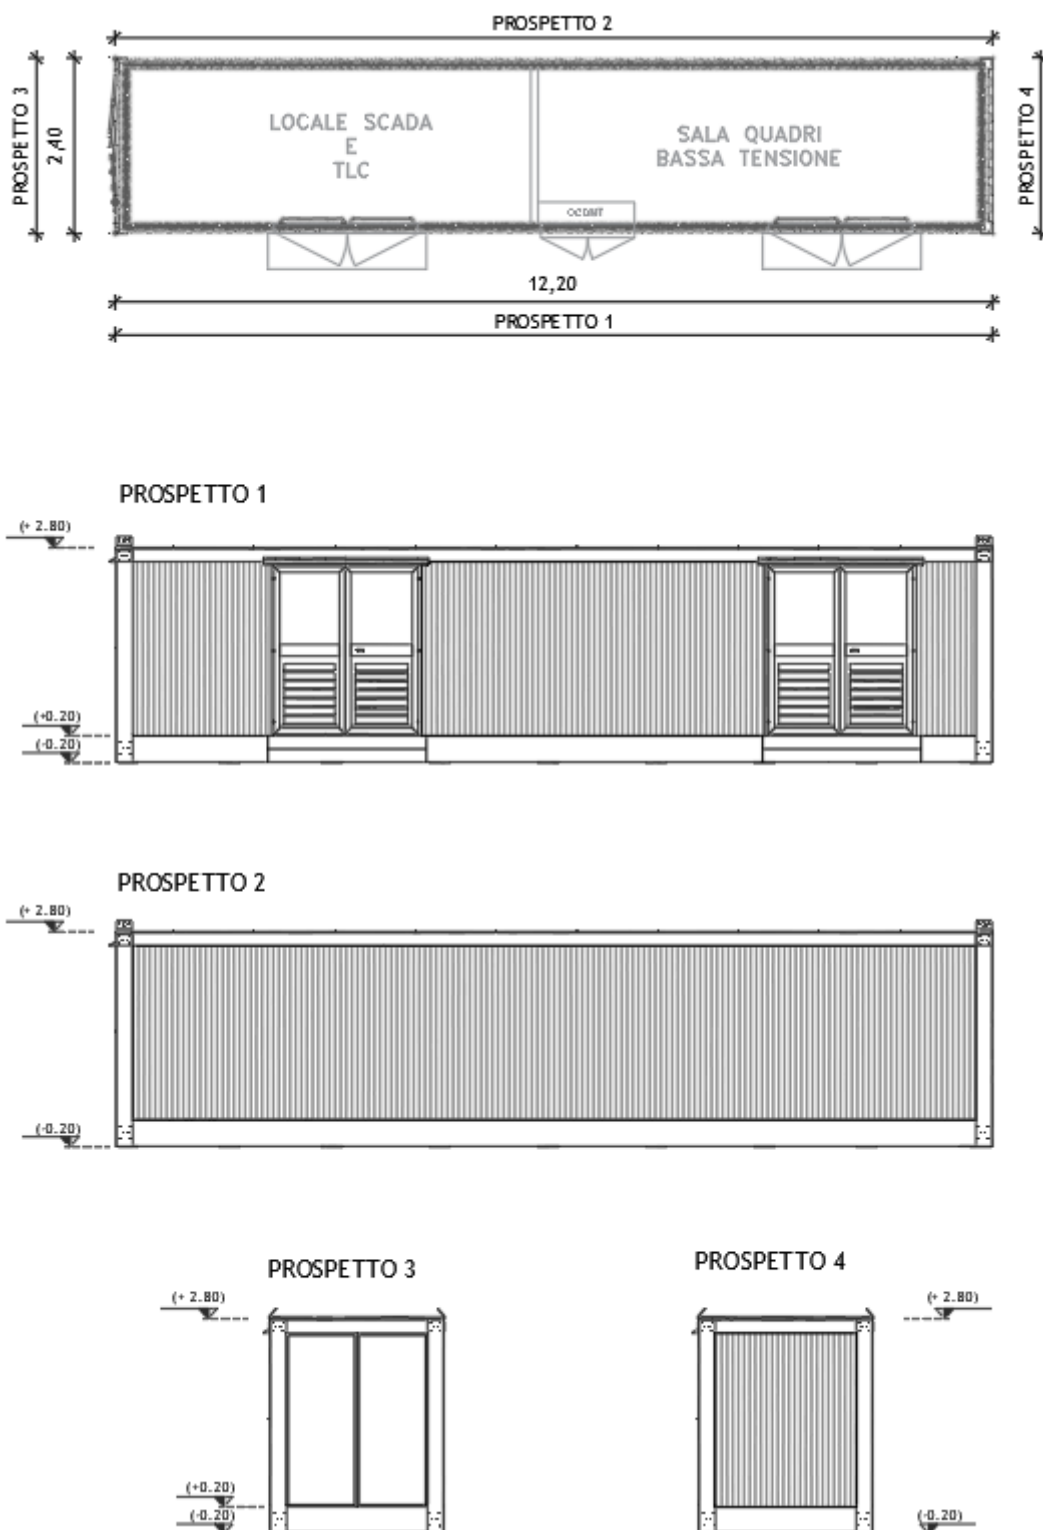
Pianta e prospetti dell'edificio B.T. + SCADA e TLC
